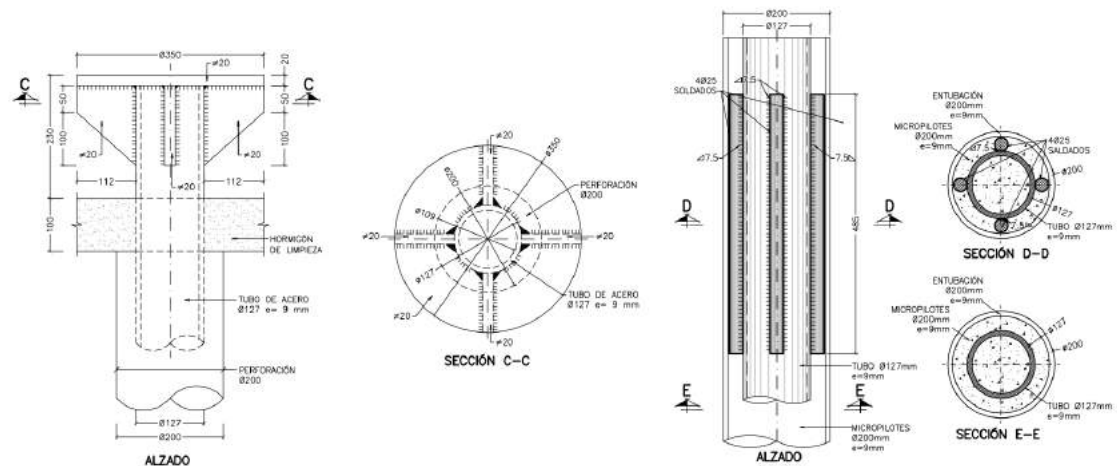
Detalles de las cabezas de los micropilotes de los recalces de las pilas
